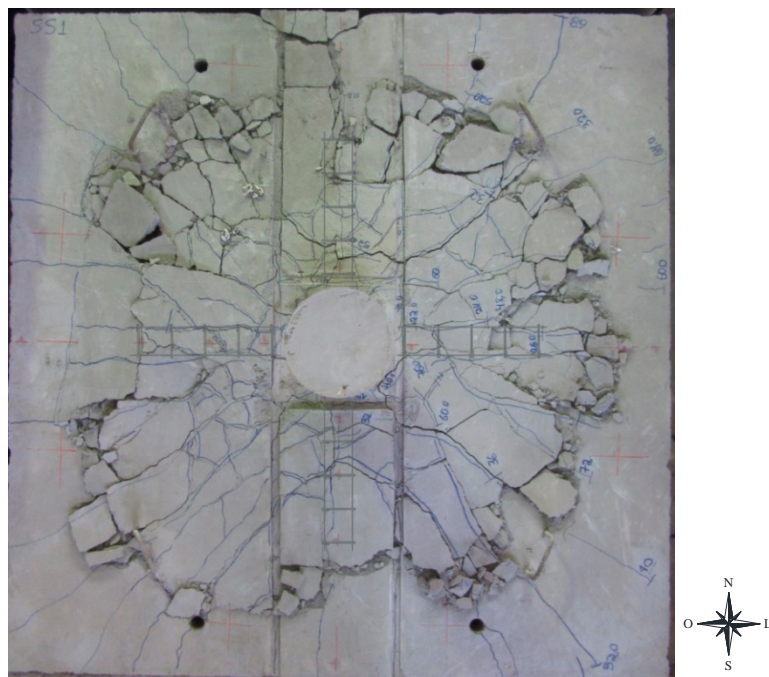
Mapa de fissuração (laje SS1)
